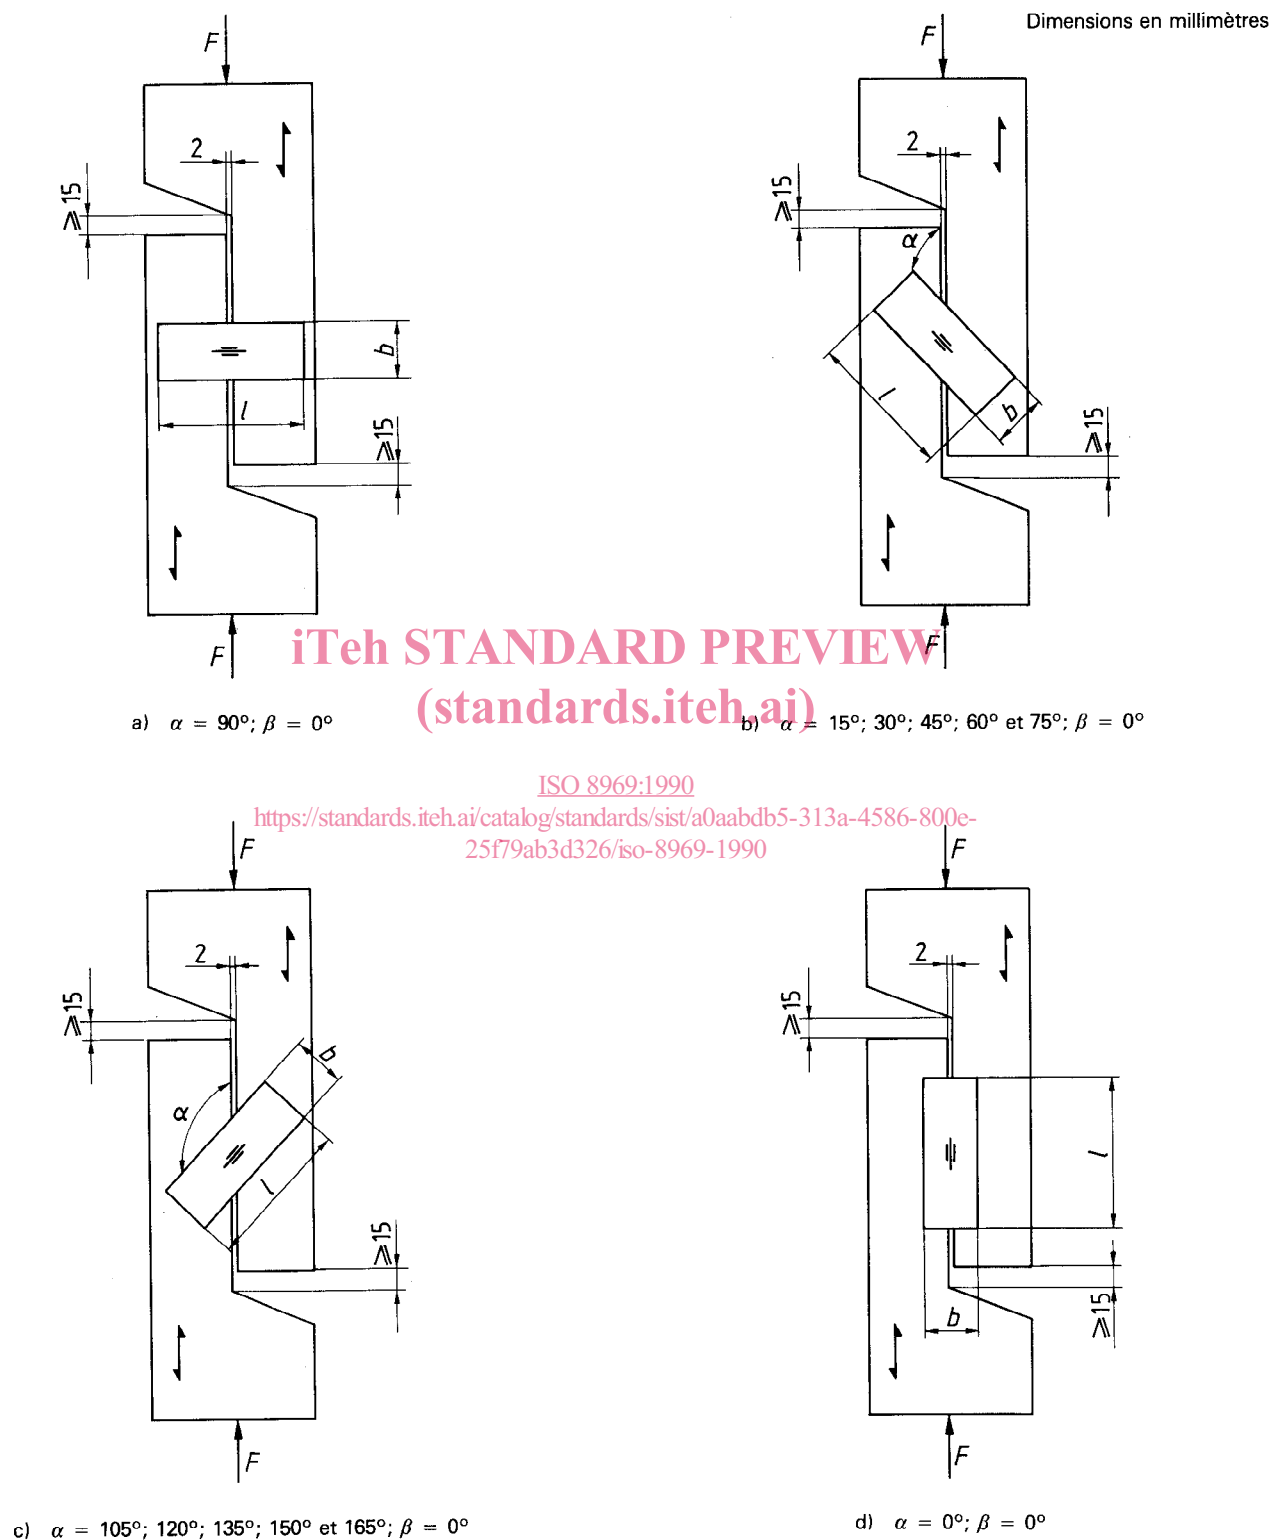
Éprouvette pour essai de résistance au cisaillement de la plaque
